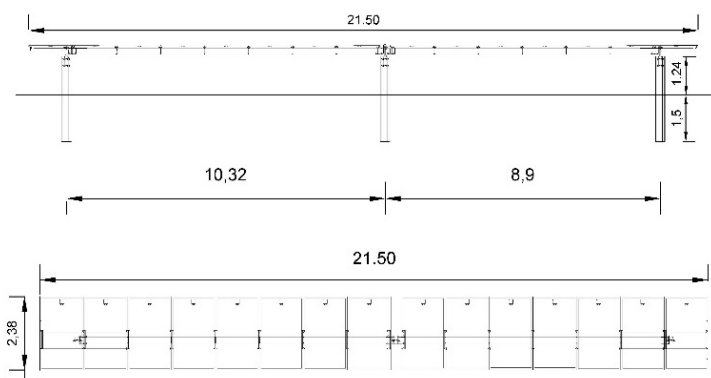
Prospetto frontale e vista in pianta delle strutture (15 moduli) ad inclinazione 0°
